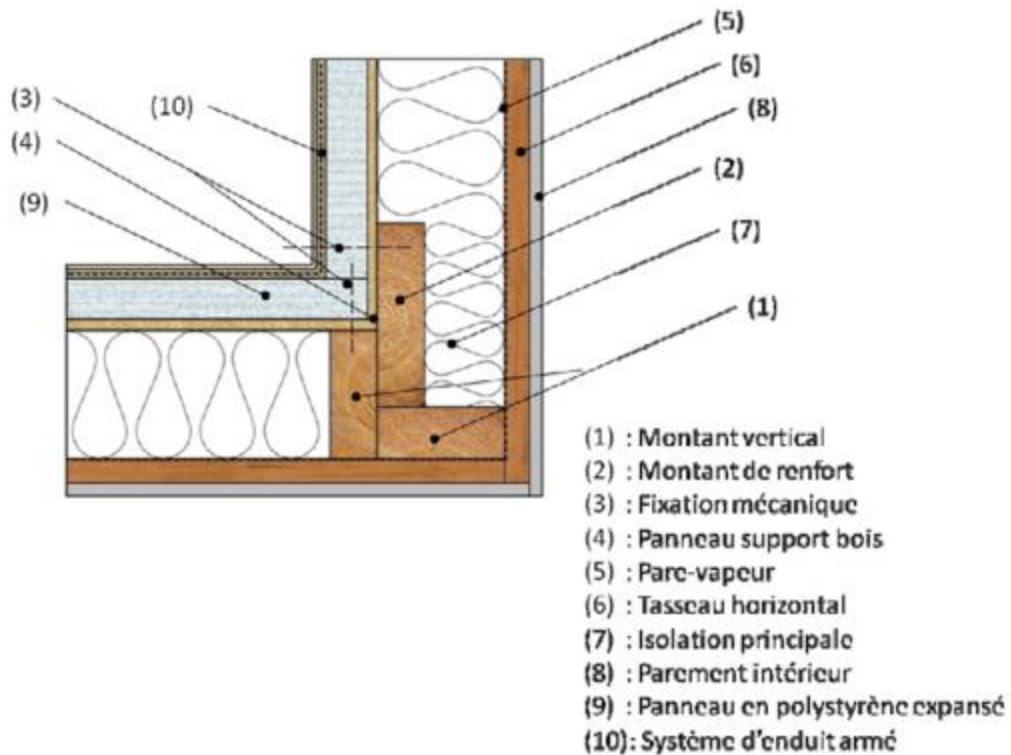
Fixations complémentaires aux angles rentrants (coupe horizontale)
